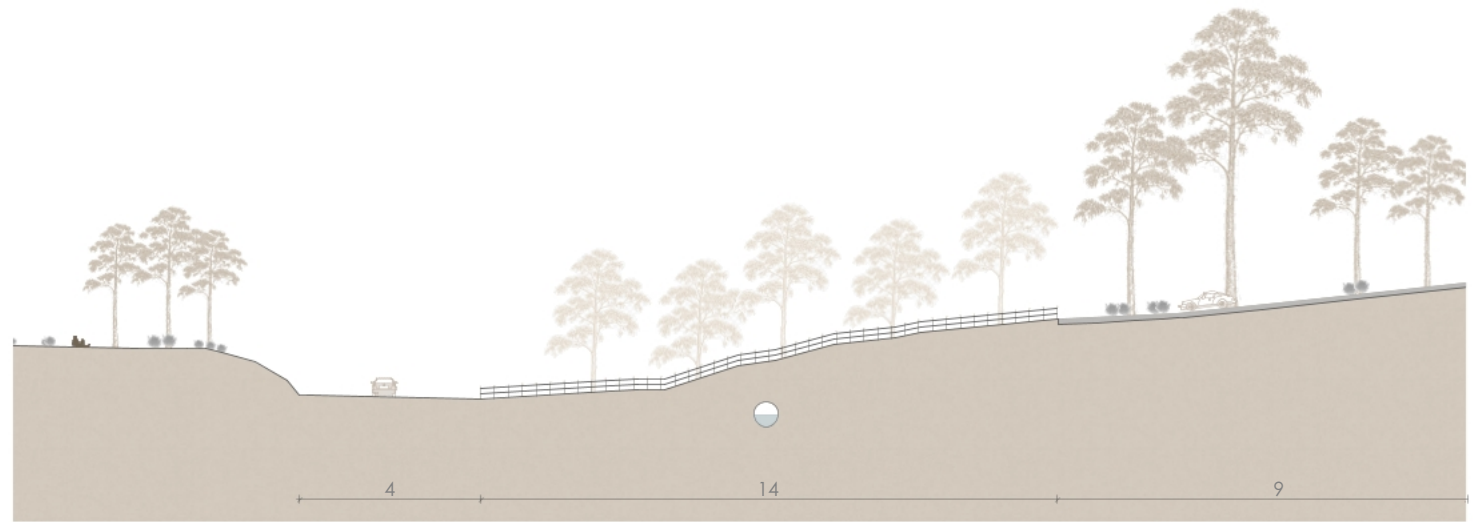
Sección Transversal 5: Cambio de pavimento a calle de tierra, quebrada embaulada debajo de la vía.
